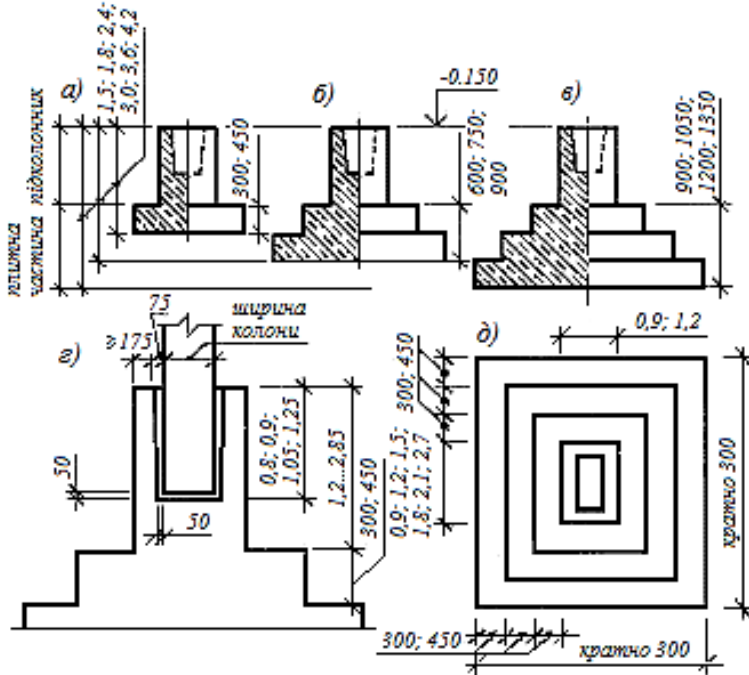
Монолітні стовпчасті фундаменти промислових будівель під збірні залізобетонні колони: а – одно-; б – дво-; в – триступінчастий; г – підколонник; д – вид зверху
